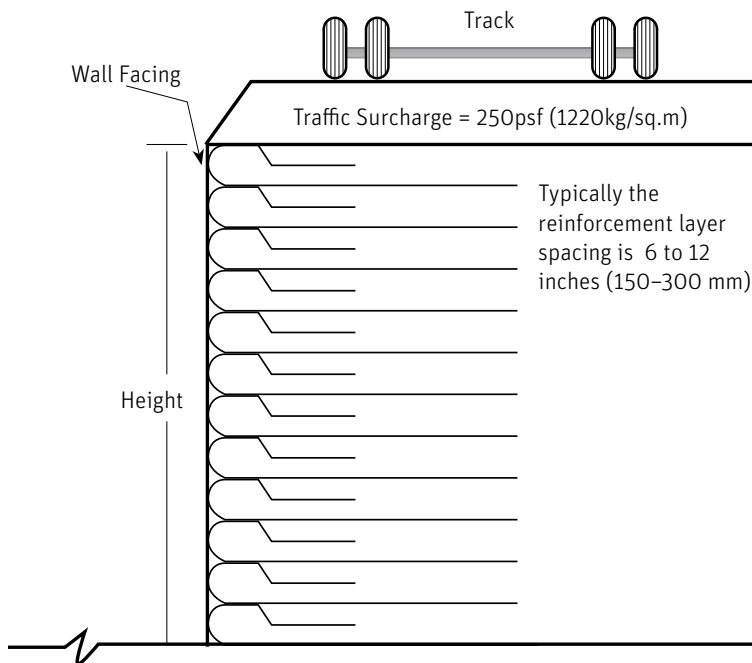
Muro con geotextil que soporta el prisma de una carretera
